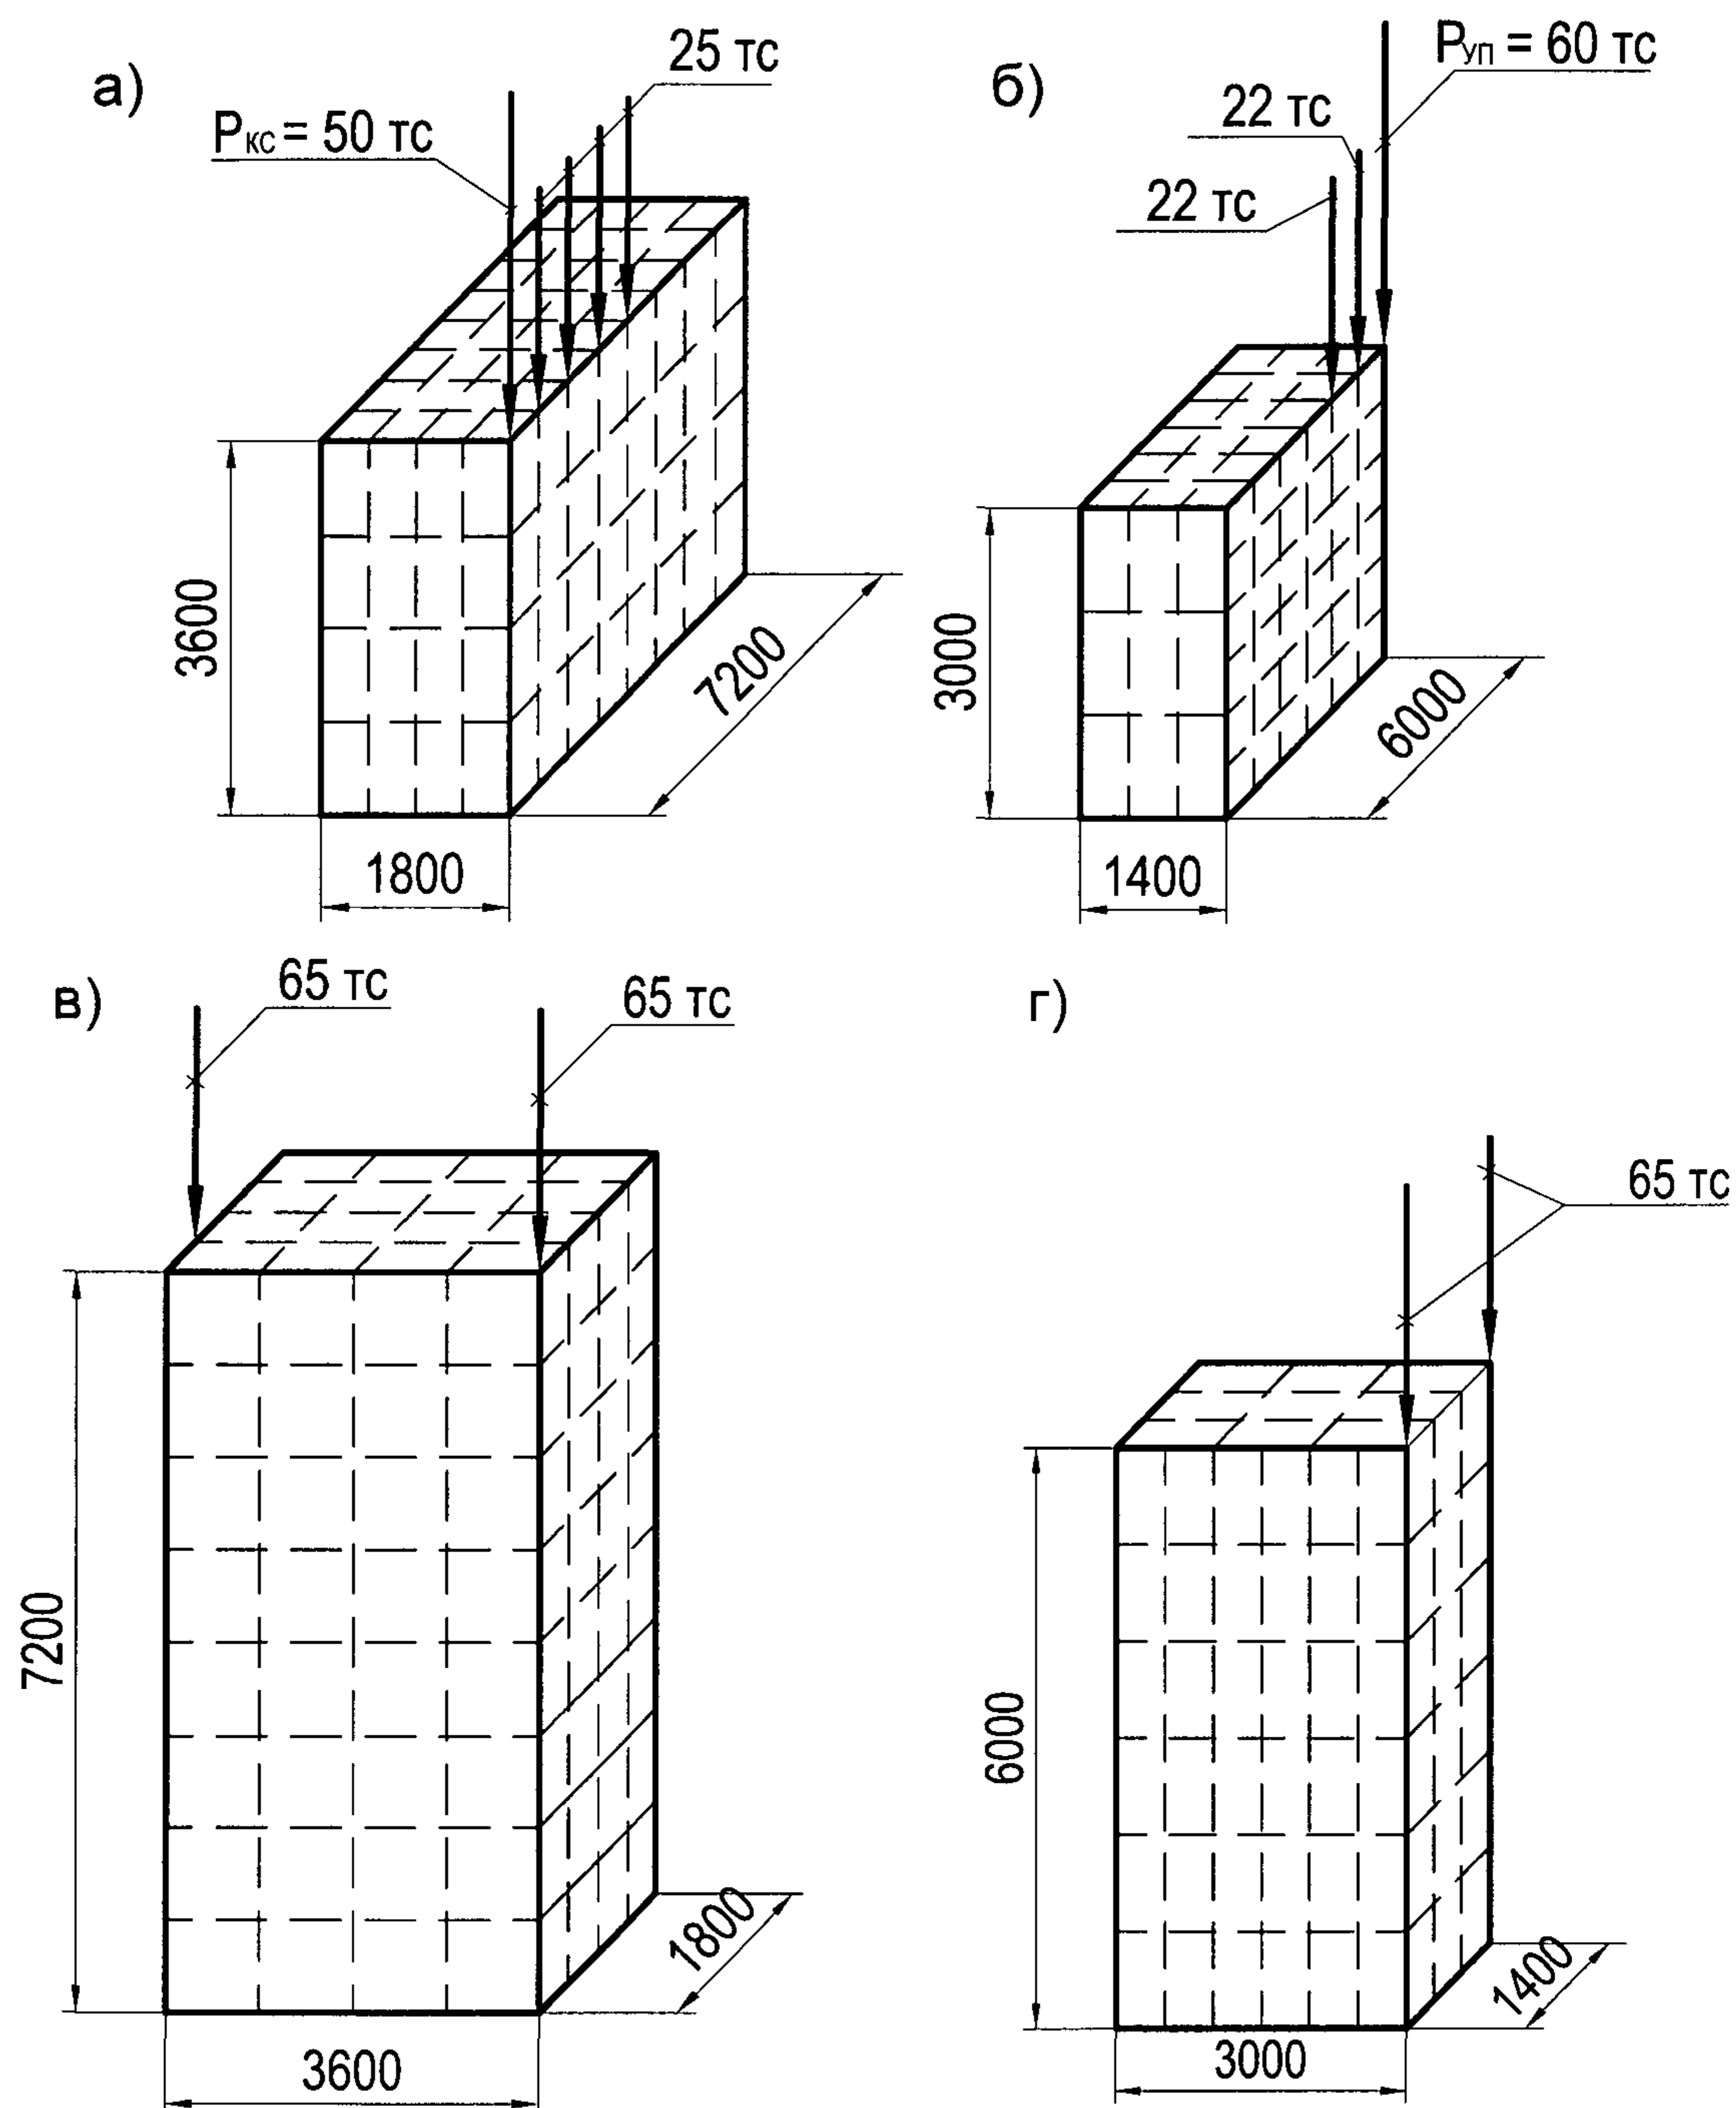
Схема предельных нагрузок на понтон при использовании его в конструкциях подмостей
